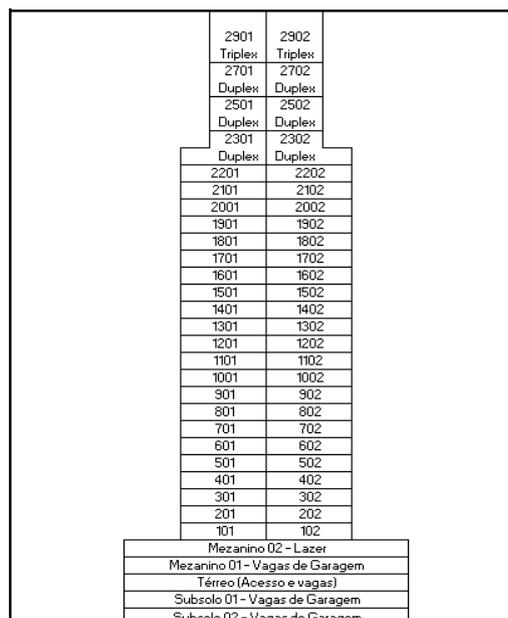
Visão geral do empreendimento com 36 pavimentos
